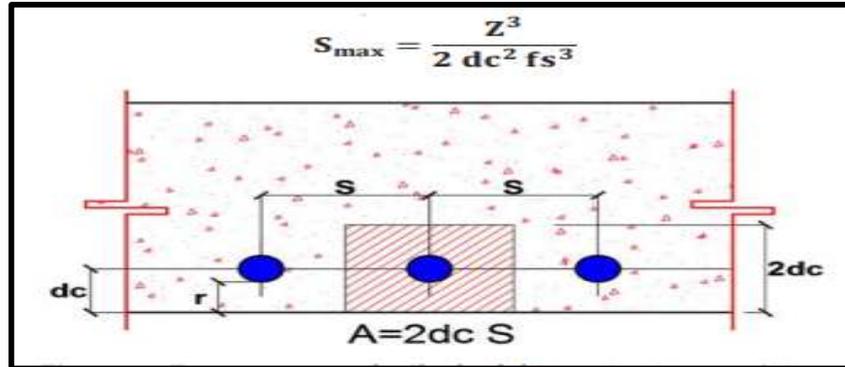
Esquema para el cálculo de espaciamiento máximo para control de fisuras.
